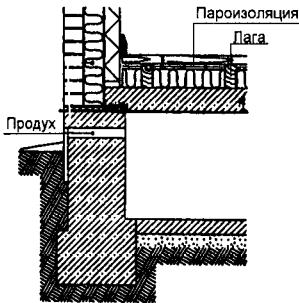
Конструктивные решения междуэтажных перекрытий
